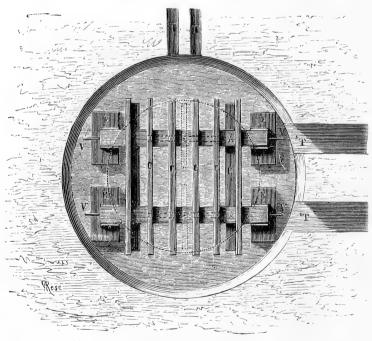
Plan du plancher destiné à soulever le Cèdre.
